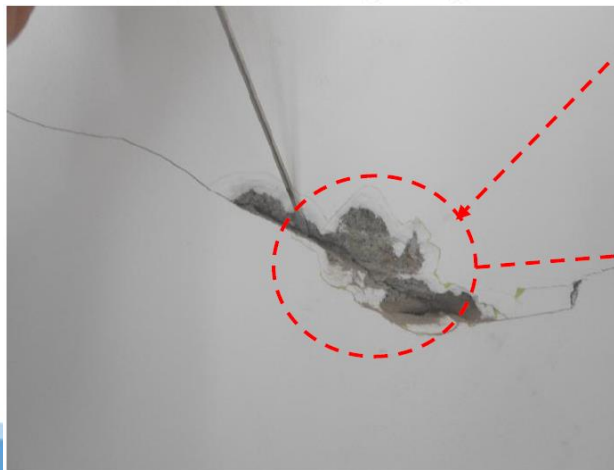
Detalhe 2 da fissuração no quarto.
